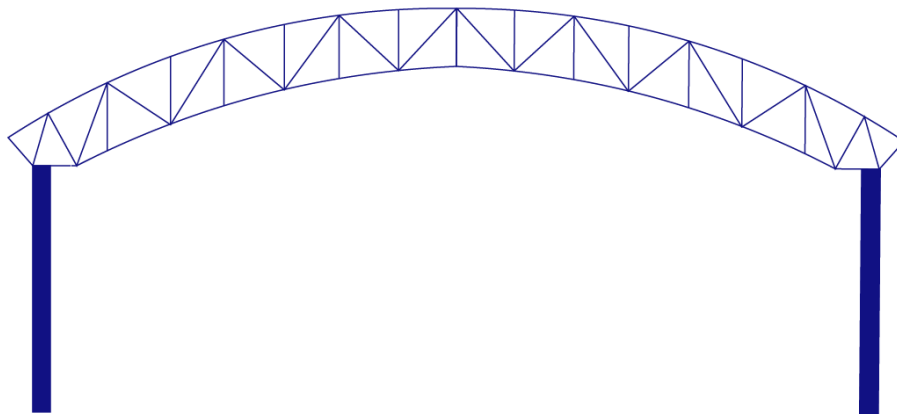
Estructura parabólica sobre columnas de hormigón armado
